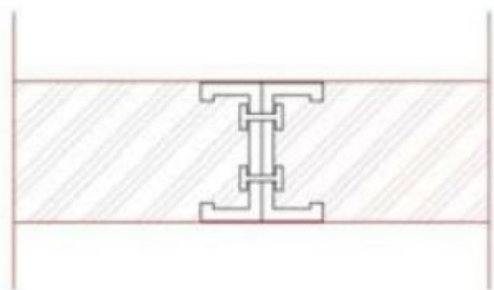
Ligação (SS). Fonte: Portal metálica, 2011.
